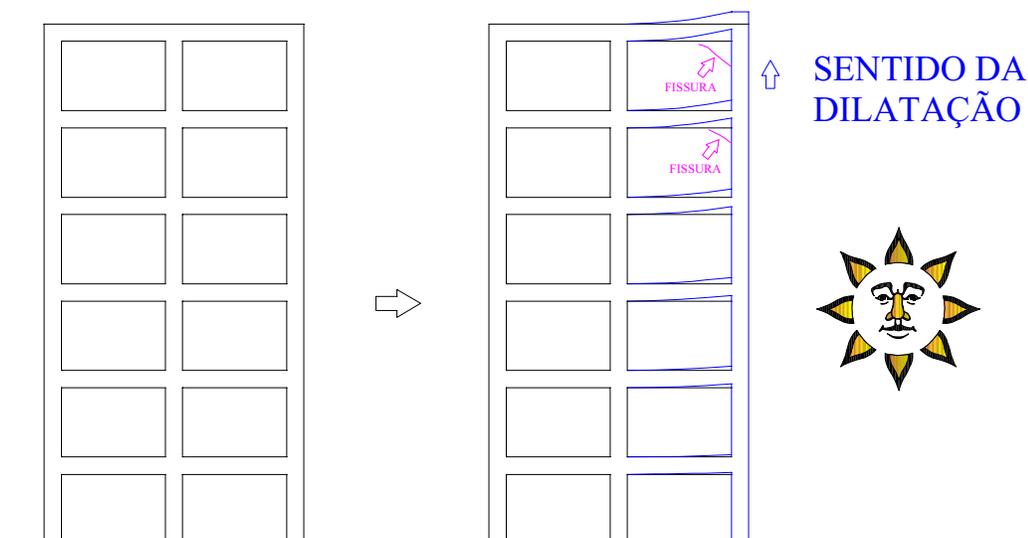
Fissuras de cisalhamento em alvenarias nos últimos pavimentos
